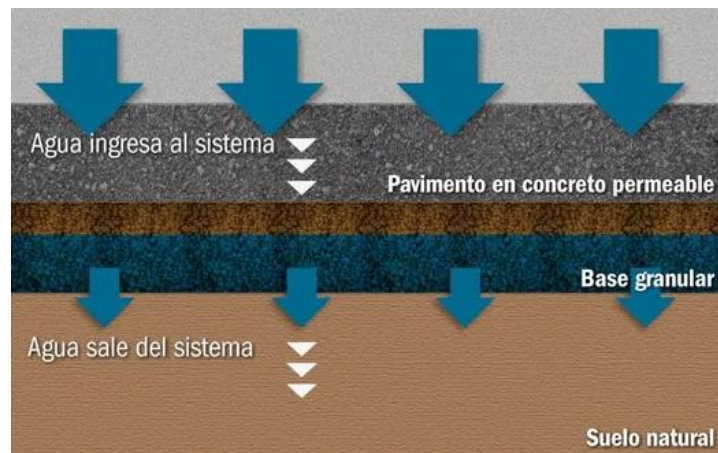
Detalle d estructura de pavimento de concreto permeable. Fuente: 360enconcreto.com
